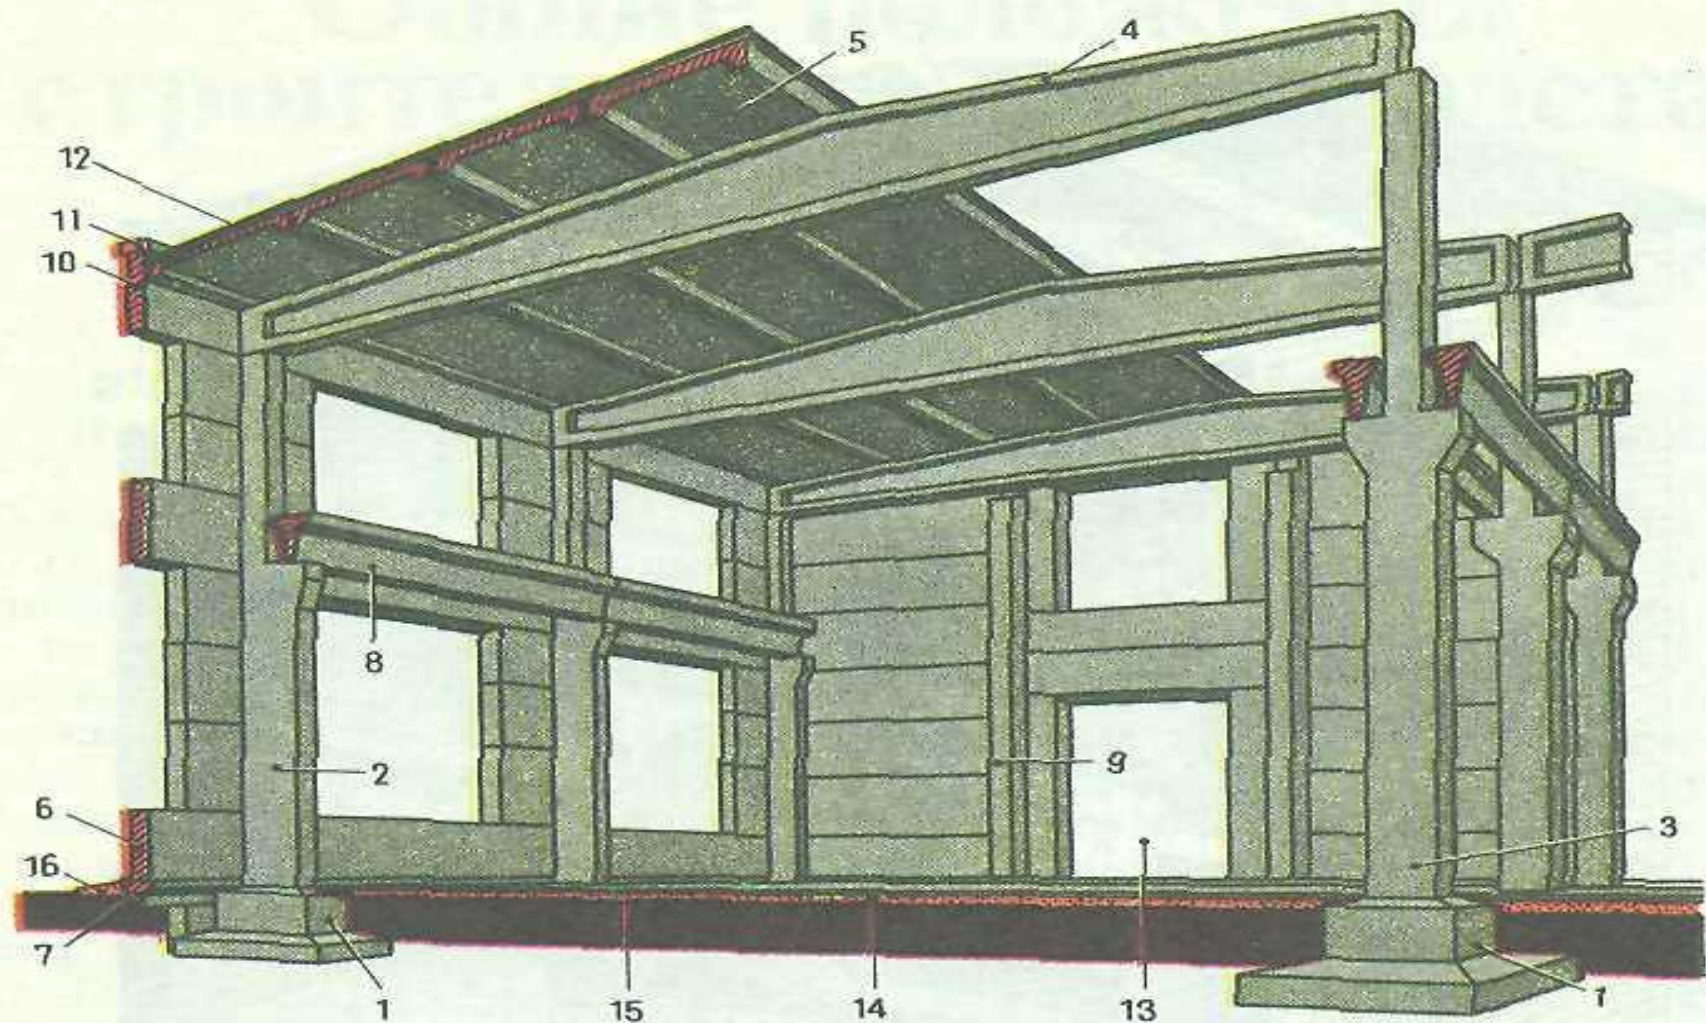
Конструктивная схема каркаса одноэтажного промышленного здания
